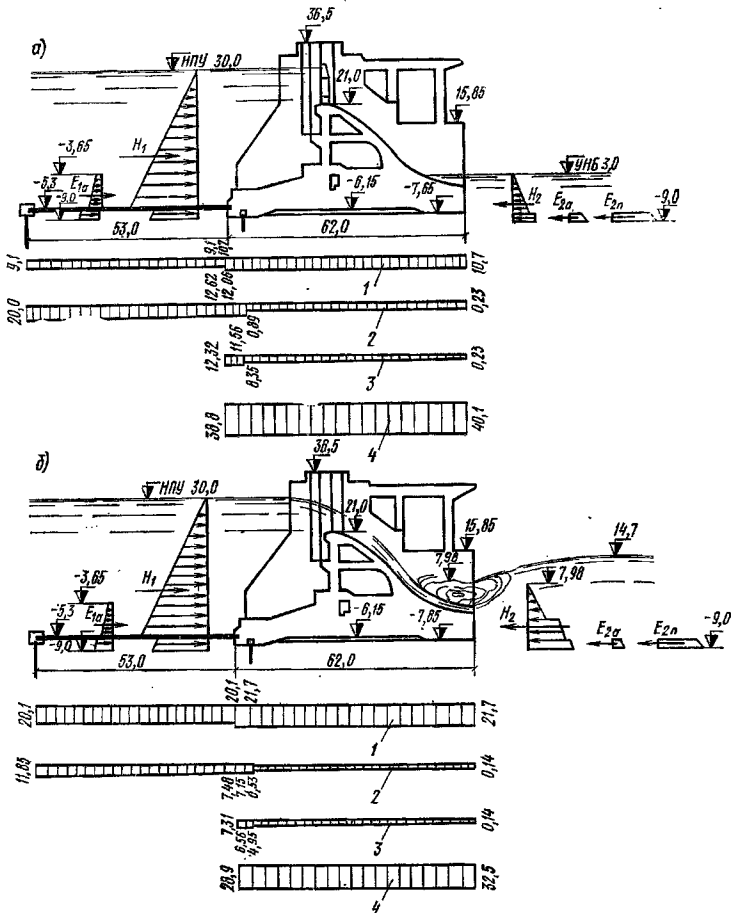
Схемы нагрузок для плотин на нескальном основании
